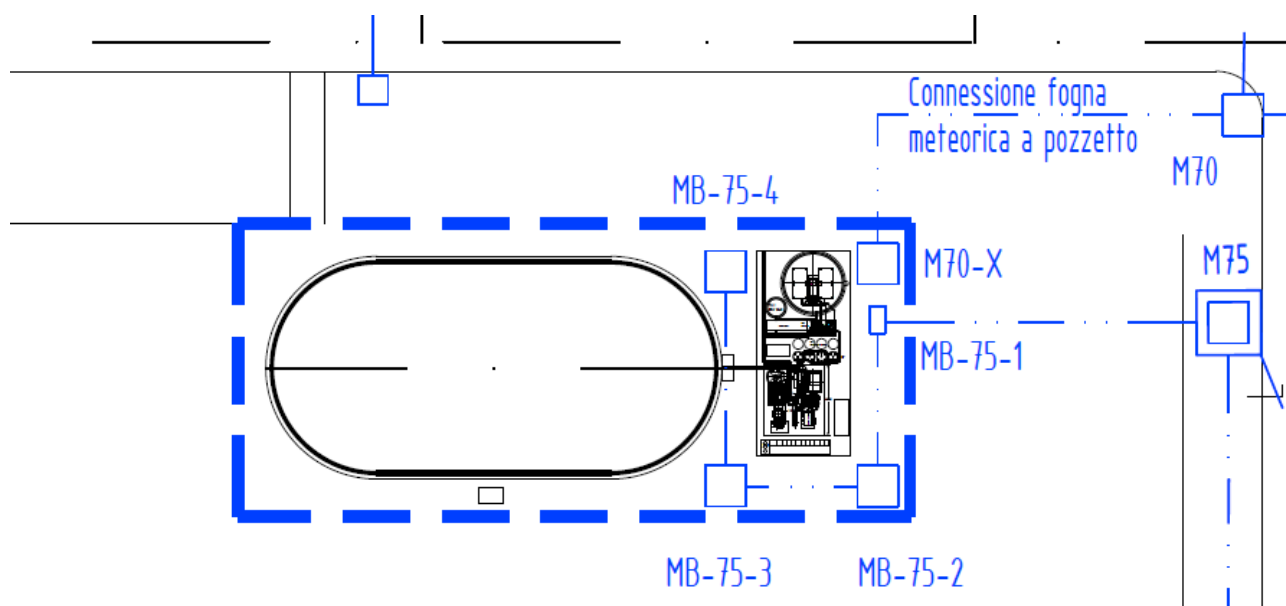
Dettaglio della planimetria della rete fognaria, la planimetria della rete fognaria dell'intero stabilimento di Ottana si può trovare nell'Allegato C – Elaborati grafici
